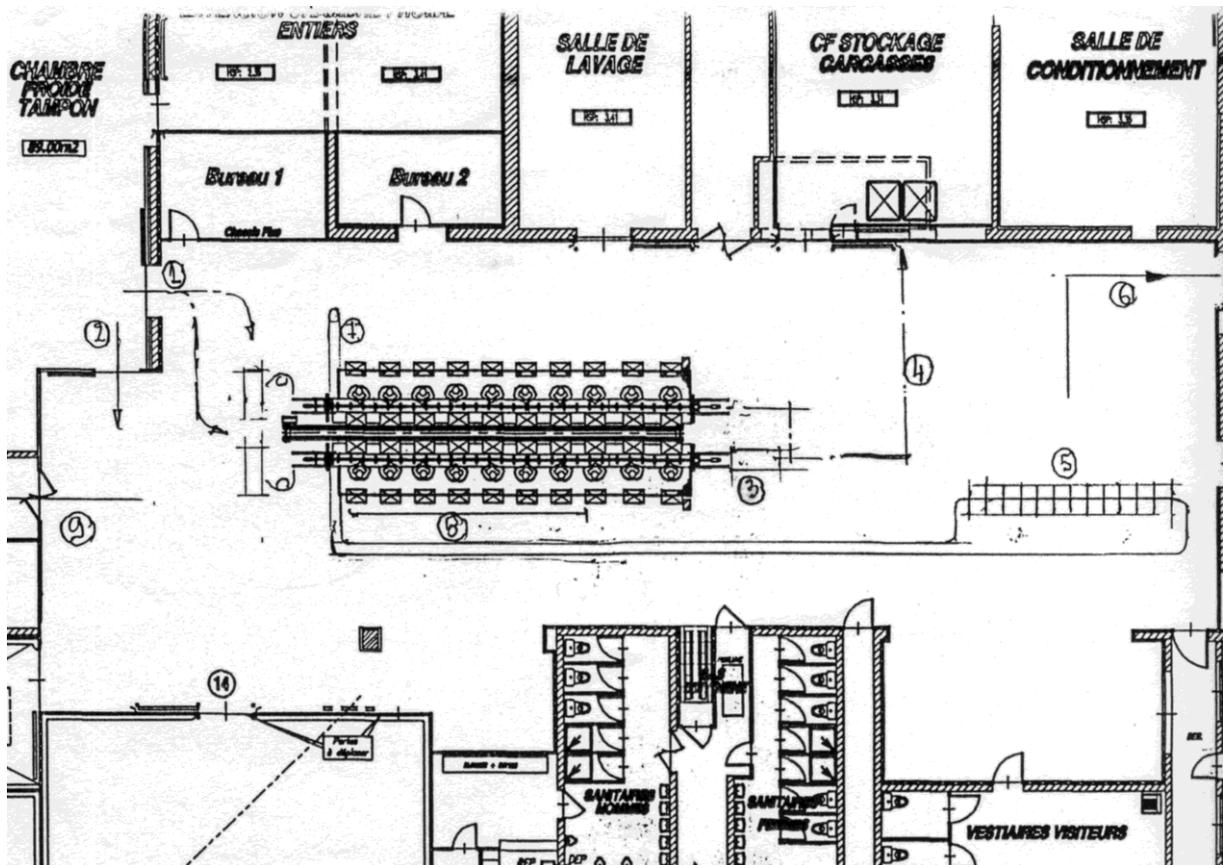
Plan prévu pour l'atelier découpe (janvier 2002).
